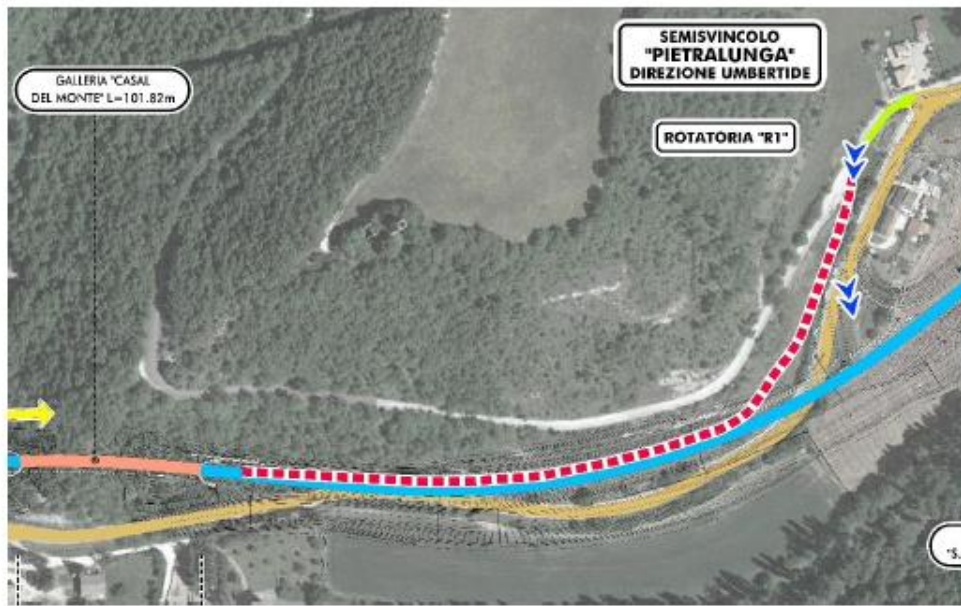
Planimetria con indicazioni della pista di cantiere per il collegamento dell'area di lavoro presso l'imbocco Est della Galleria Molinello (Estratto dall'elaborato T00CA01CANPL01A)
